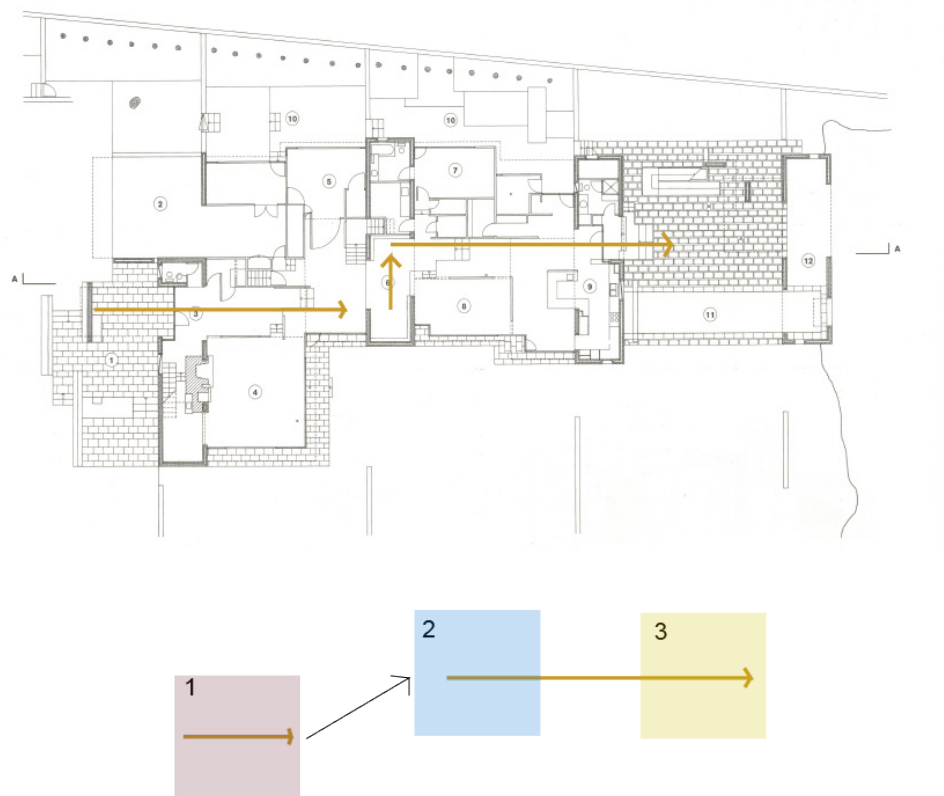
Esquema en planta de la Stretto House de Steven Holl indicando una desviación del eje de recorrido arquitectónico (musicalmente: modulación de la tonalidad) y la subdivisión en módulos temáticos o partes.
